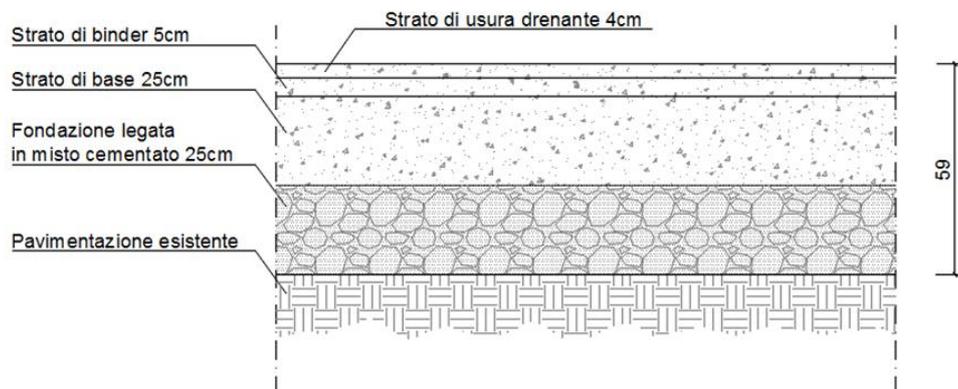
Pacchetto di ripristino pavimentazione autostrada TIPO P5A
